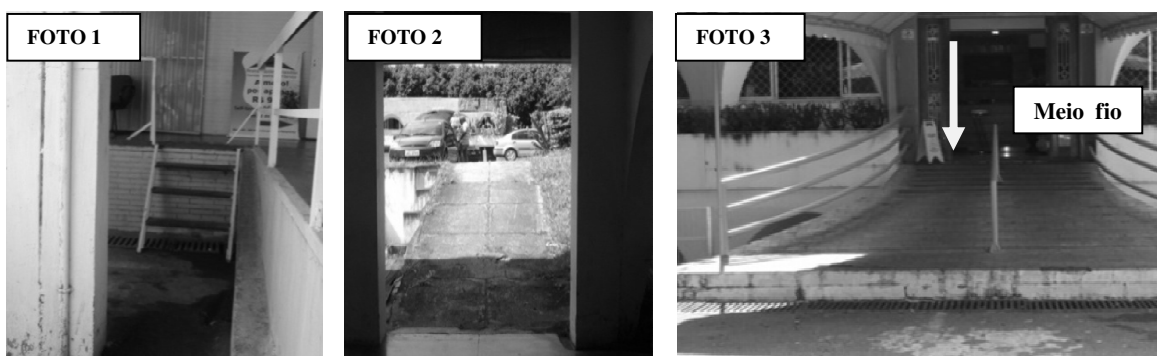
Foto 1, escada 206NAE1; Foto 2, rampa 206NAR1; Foto 3, rampa 206NAR2
